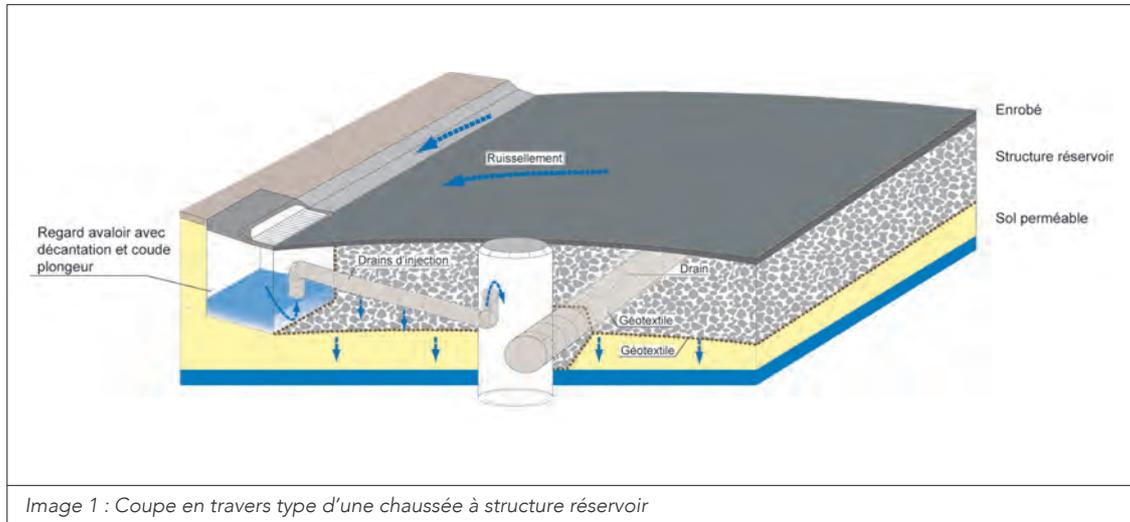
Coupe en travers type d'une chaussée à structure réservoir
